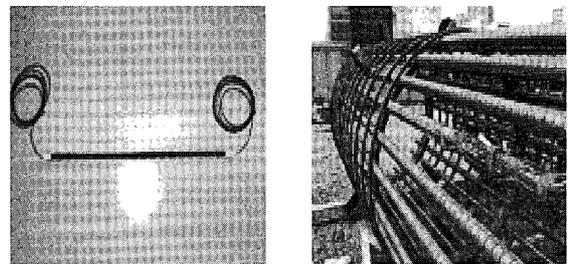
カーボン繊維センサー 写真-2 センサーの取付け
